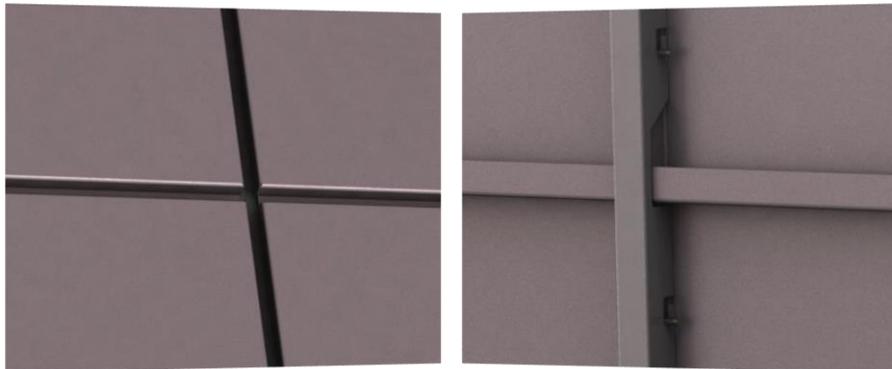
Visualización 3D del sistema de fachada ventilada a base de cassetts metálicos con un sistema de anclaje patentado por Simplex Group. Fuente: Simplex Group.
